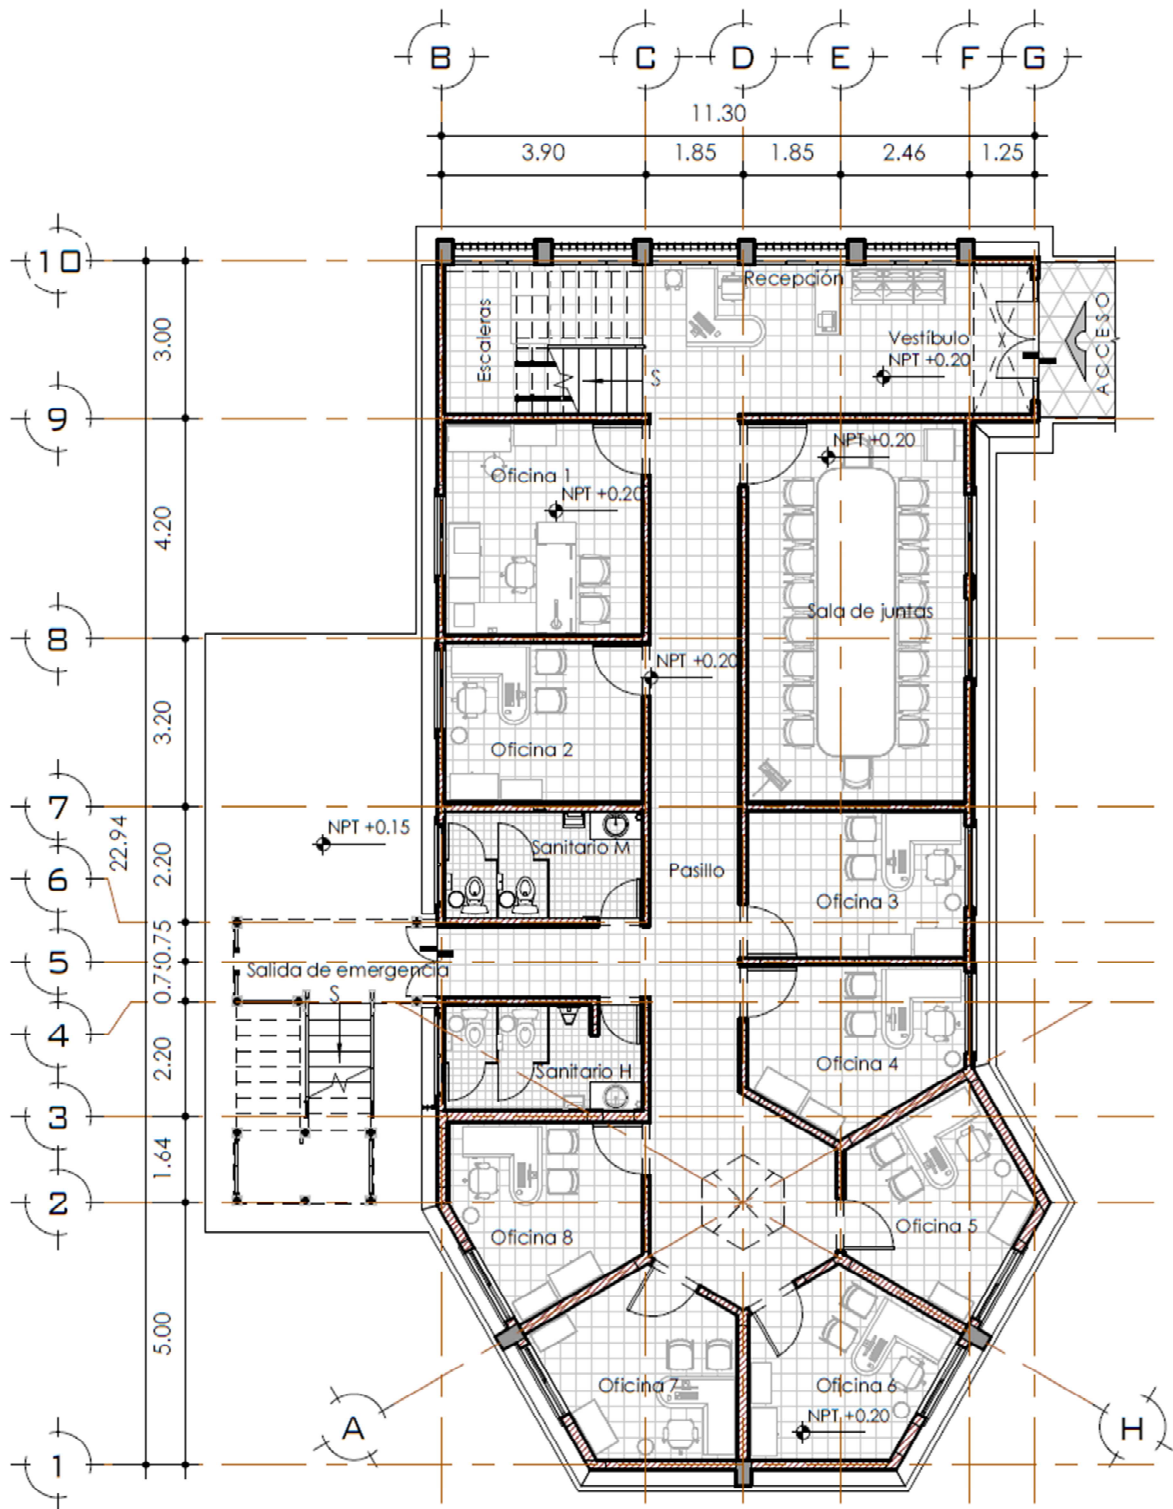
Planta arquitectónica baja (ver detalle en plano A-ARQ-01). Escala 1:125
